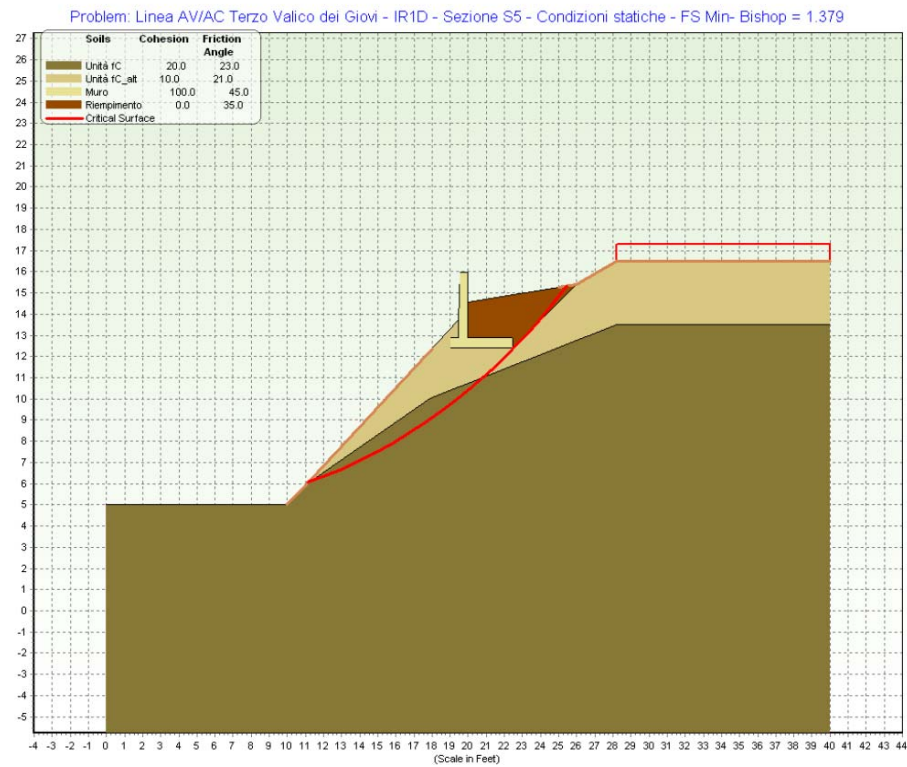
Verifica di stabilità locale condizioni statiche sezione pk 0+108.42
